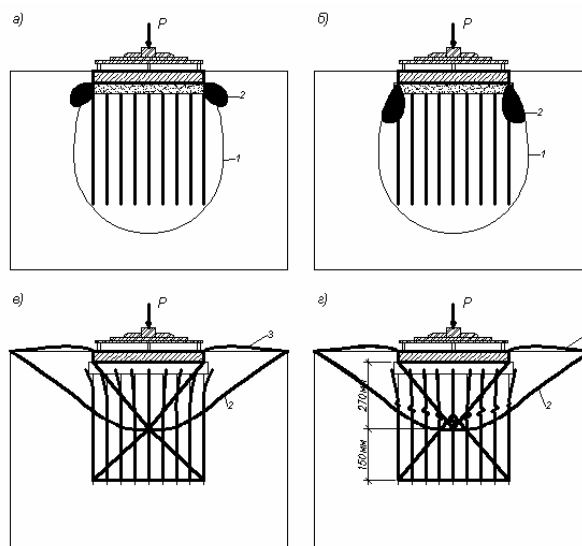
Развитие зон предельного равновесия грунта армированного основания:
